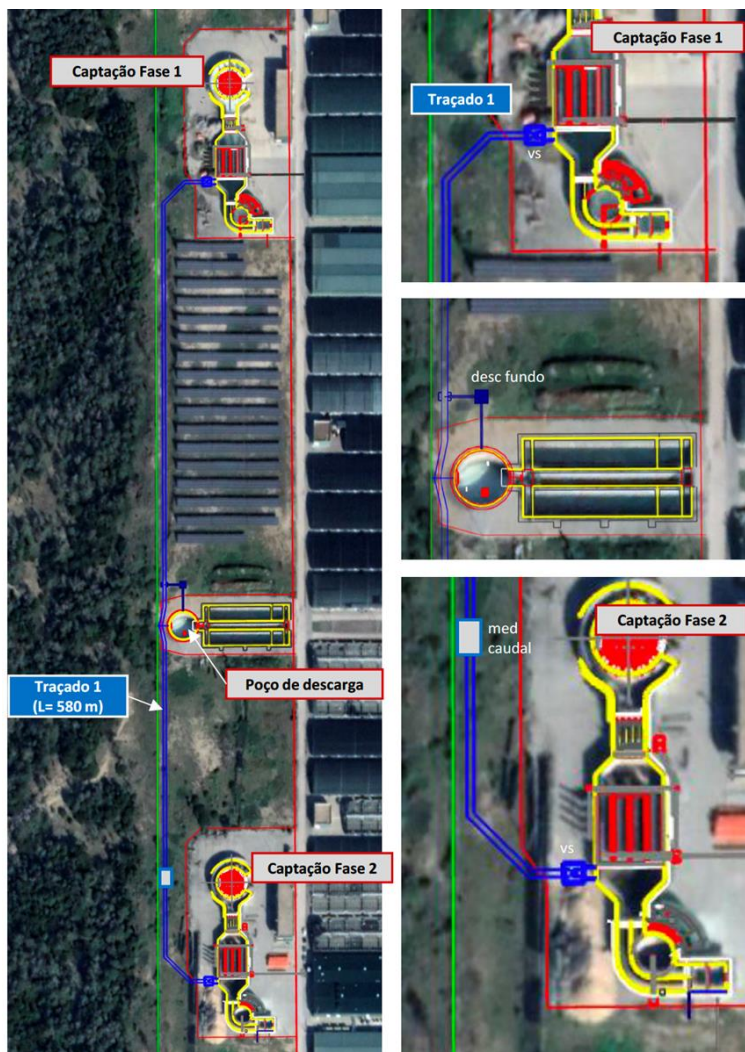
Esquema geral do traçado da conduta de interligação (COBA, 2021)
